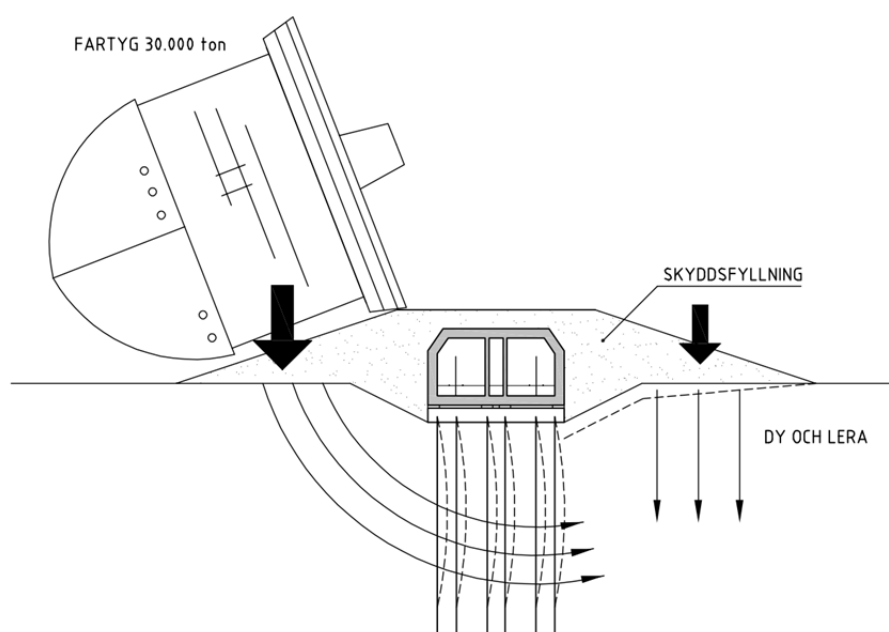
Ett kapsejsande fartyg eller lasten från skyddsfyllningen kan knäcka pålarna som betongtunneln grundläggs på.
